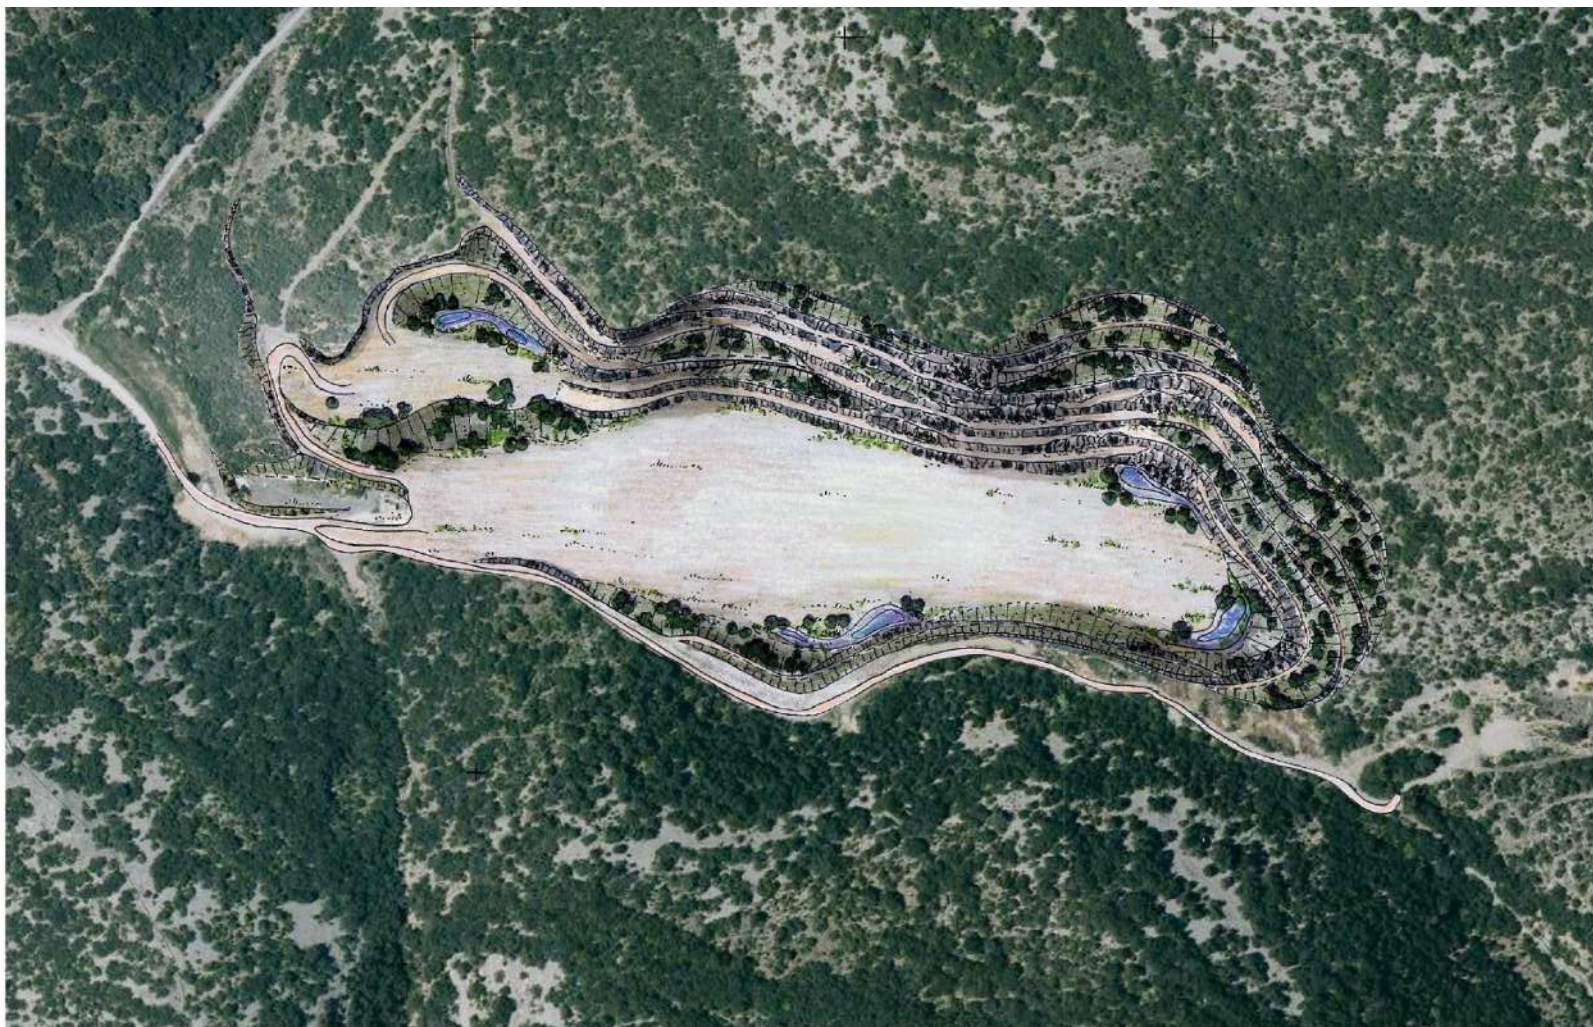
Plan du réaménagement final sur photo aérienne, échelle 1/5000^e
